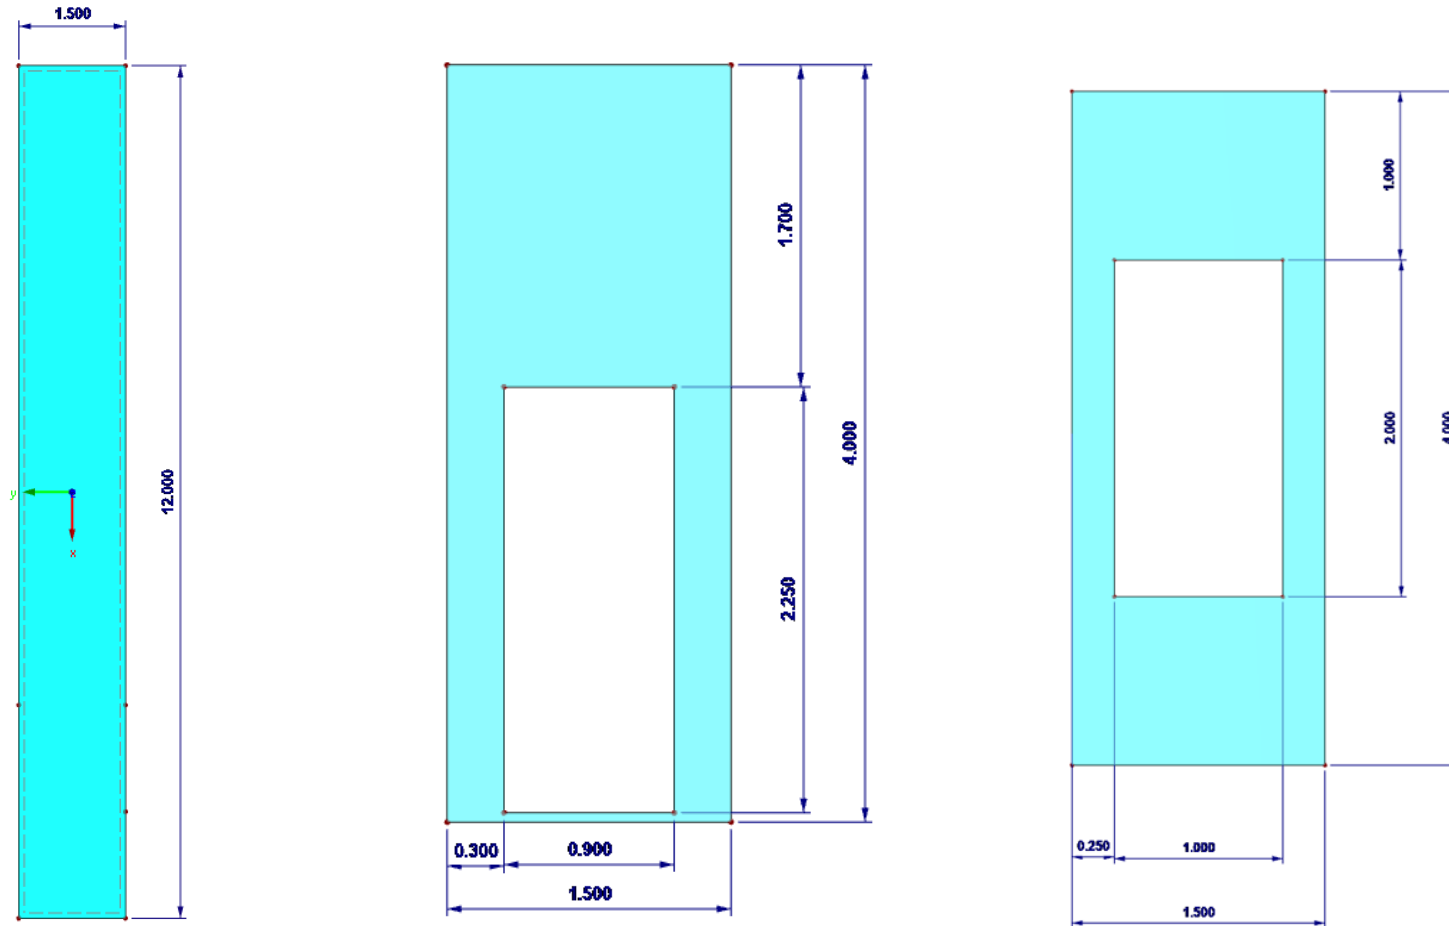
Planos: paneles de CLT recurrentes en el edificio principal.
